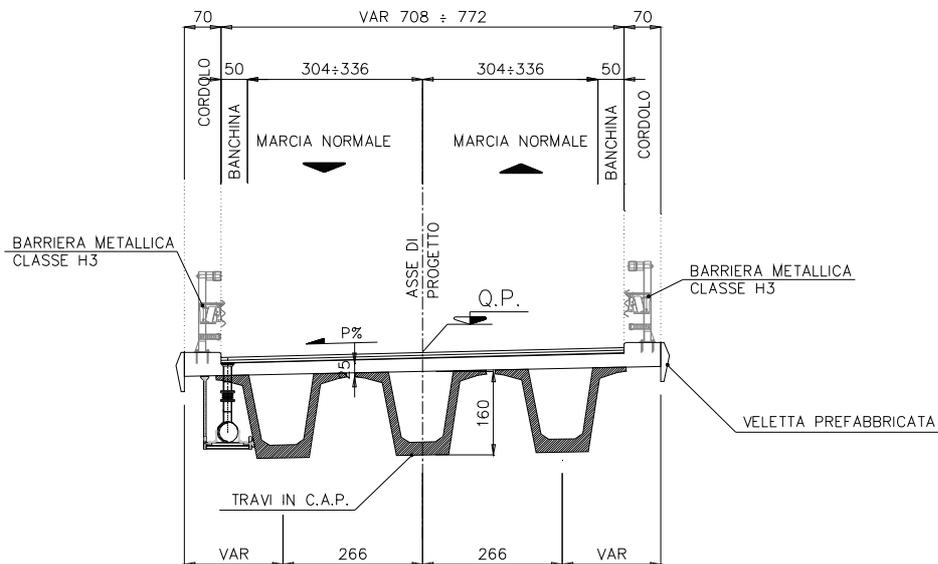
Sezione tipo impalcato Viadotto Montegemoli
